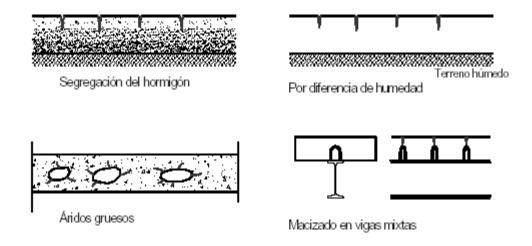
Causas principales de las fisuras por retracción hidráulica en techos y/o pisos
